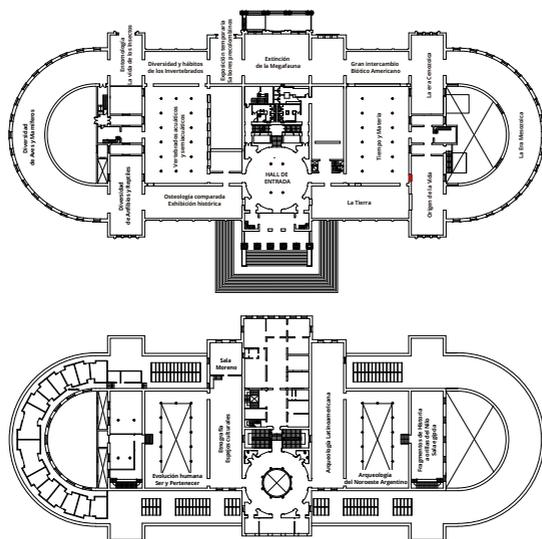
Plano de las plantas de acceso y planta alta del Museo (niveles 1 y 2) con la distribución actual de las salas. Foto: Base de datos del MLP.
